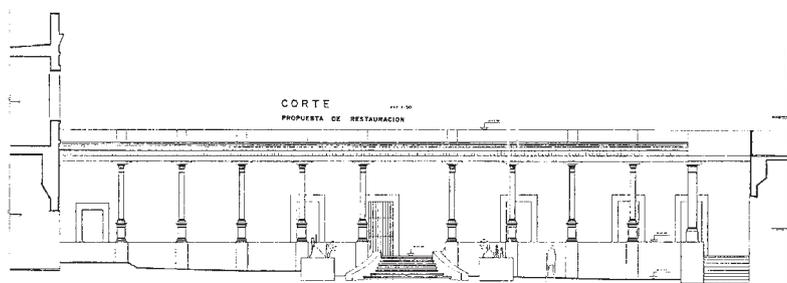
Corte hacia los portales. Propuesta de restauración.
